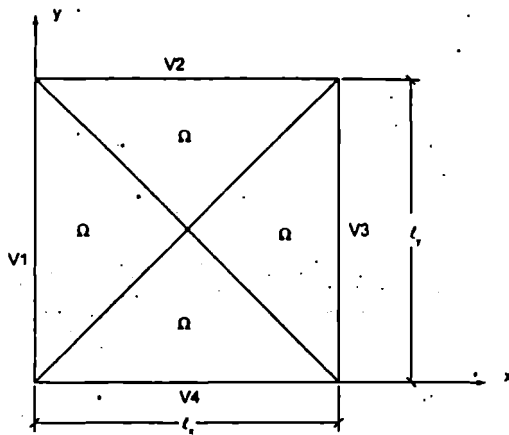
Laje quadrada apoiada nas vigas V1, V2, V3 e V4.
